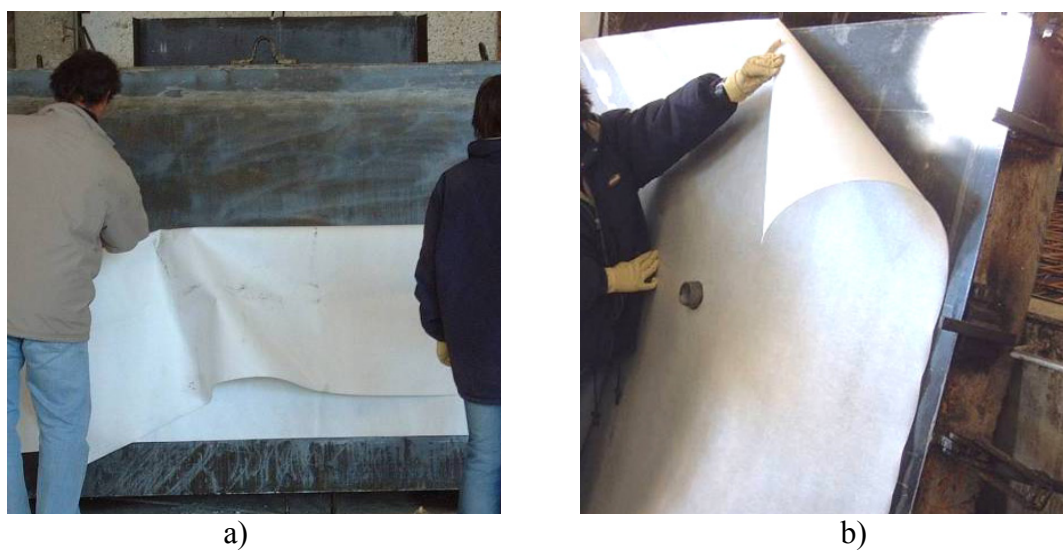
Aplicação do CPF nas faces laterais exteriores da cofragem das box-culvert:
